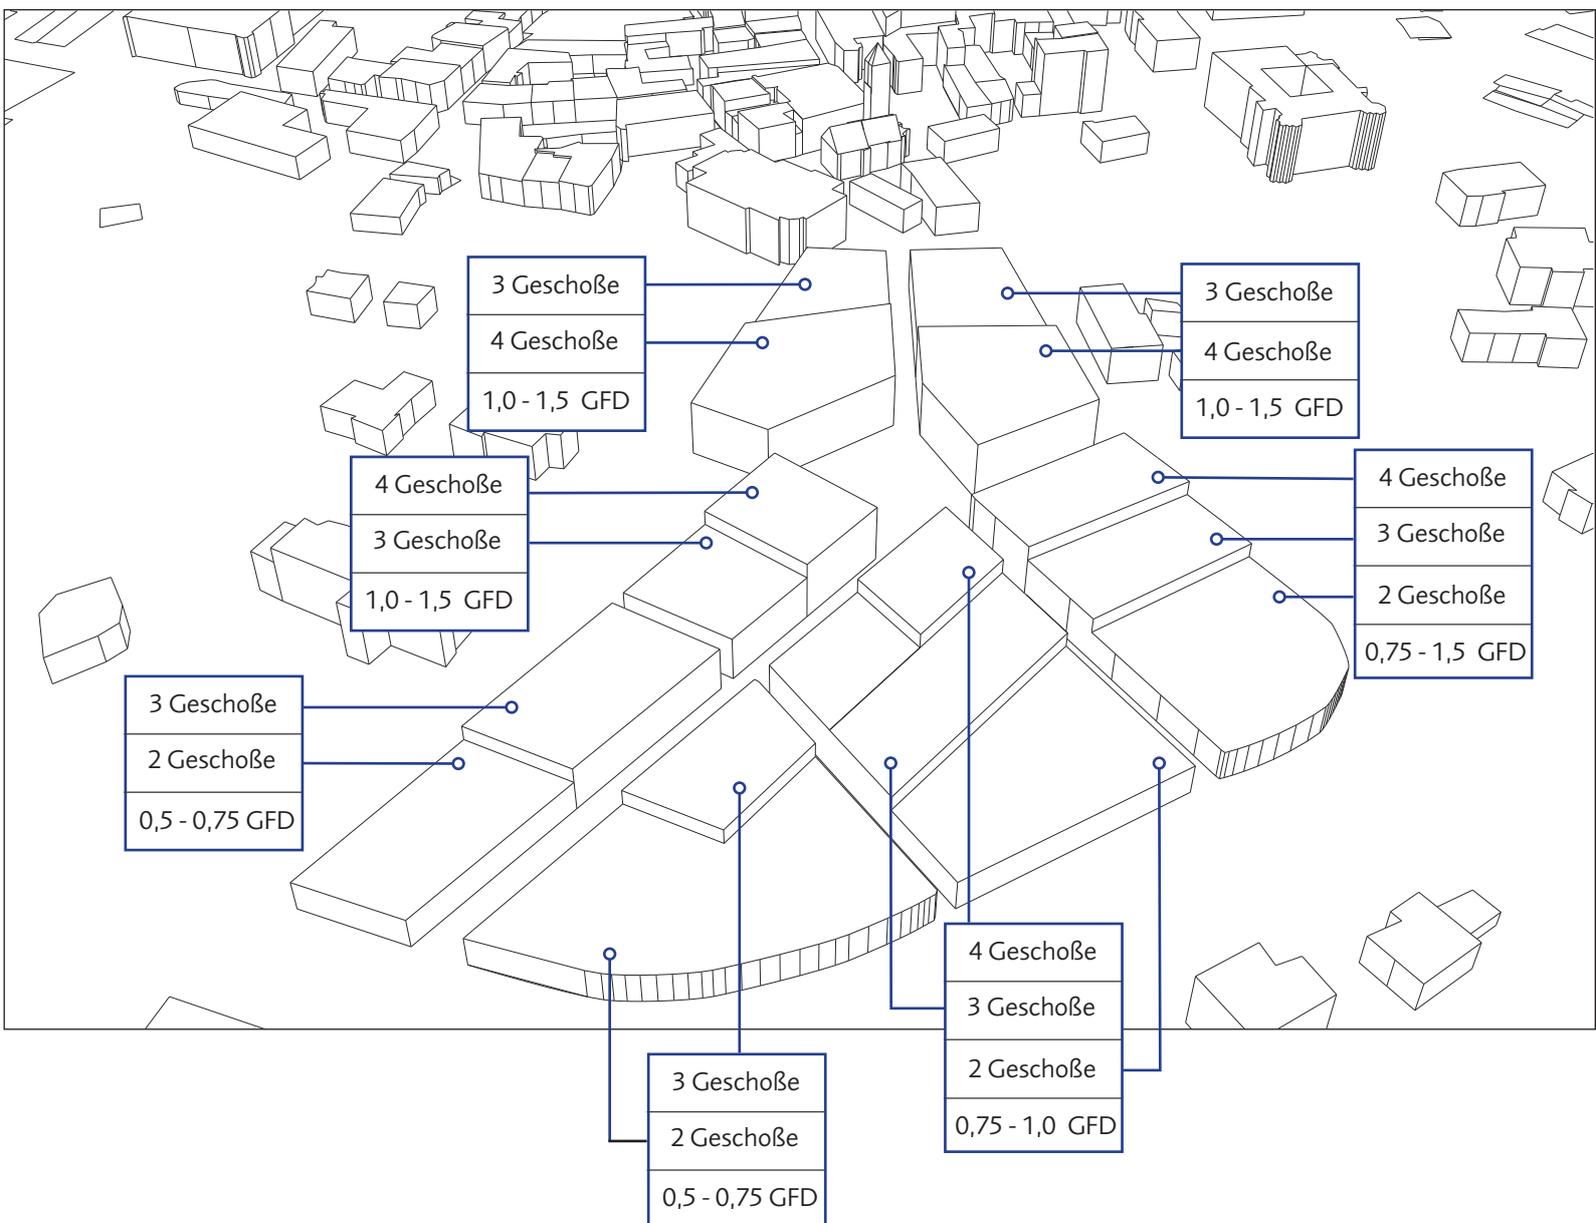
Bauliche Dichte (GFD brutto) mit Baufeldnummerierung (eigene Darstellung)
